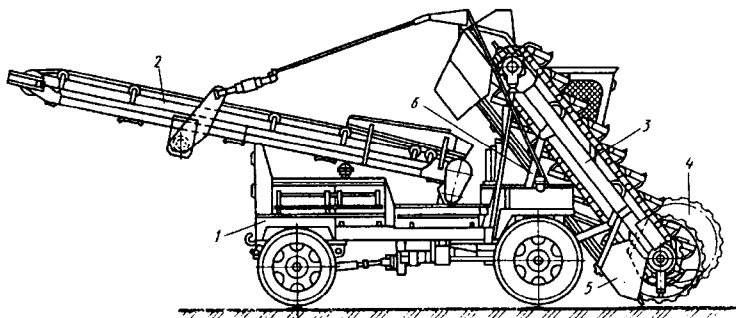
Многоковшовый погрузчик со шнекоковшовым рабочим органом: 1 — пневмоколесное шасси; 2 — конвейер; 3 — ковшовый конвейер; 4 — питатель; 5 — отвал; 6 — гидроцилиндры.
